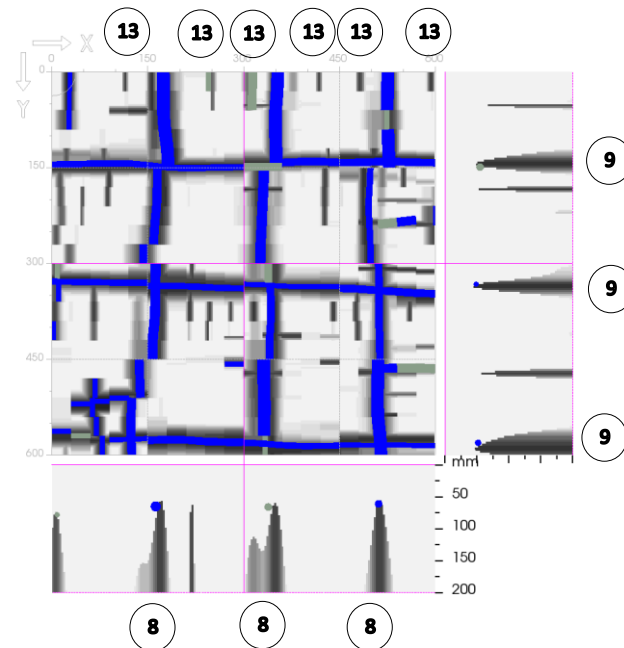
Ferrailage reconnu – Poutre Pt03
